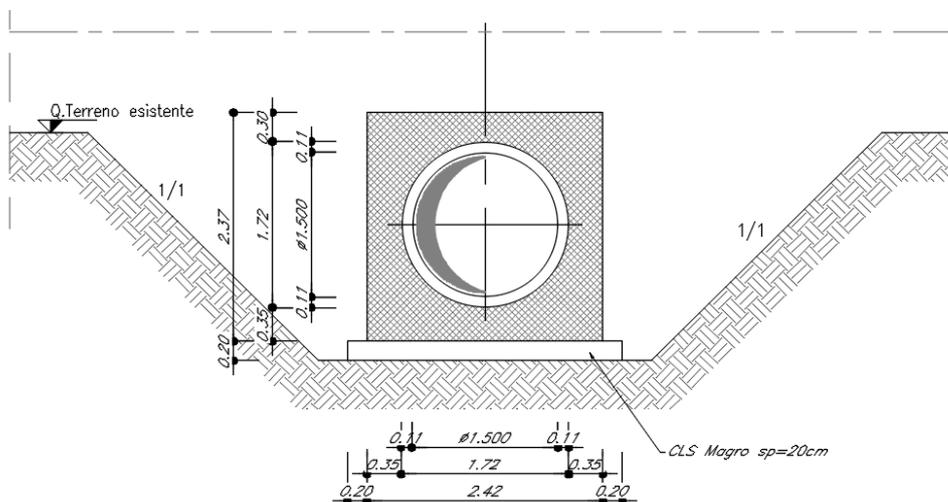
Sezione trasversale dell'opera tubo Ø1500
